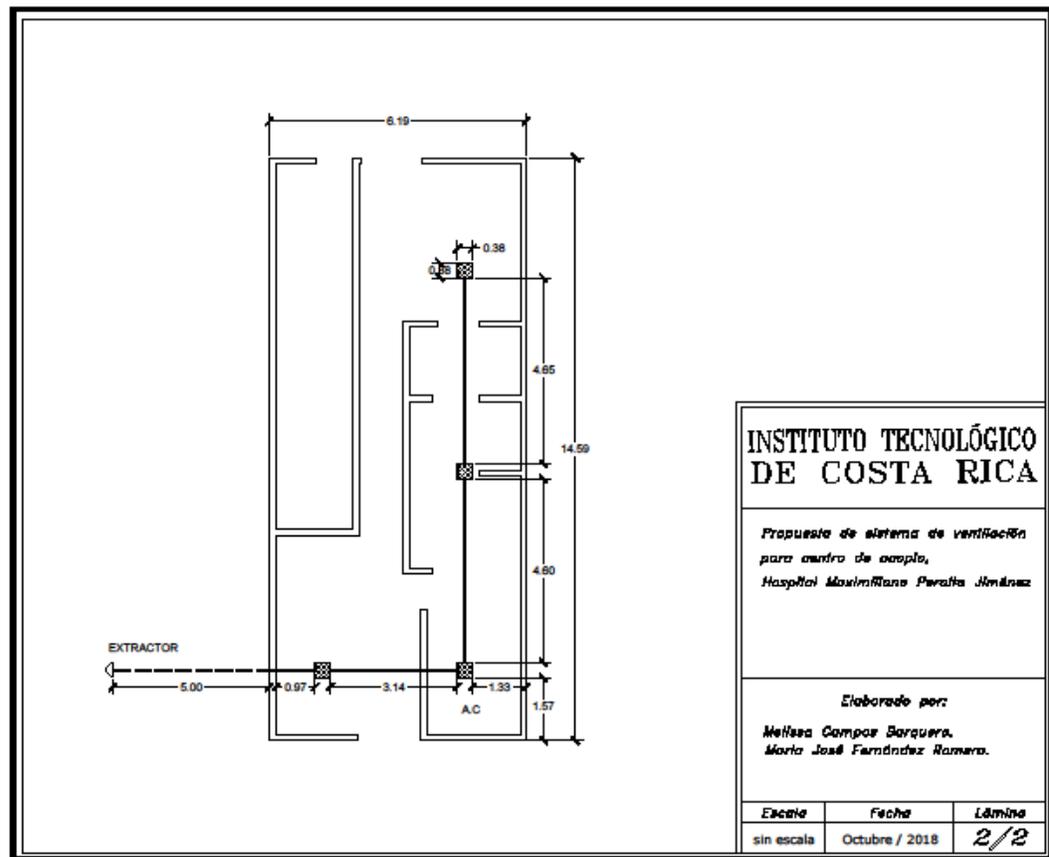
Plano en vista superior del sistema de extracción propuesto para el centro de acopio
